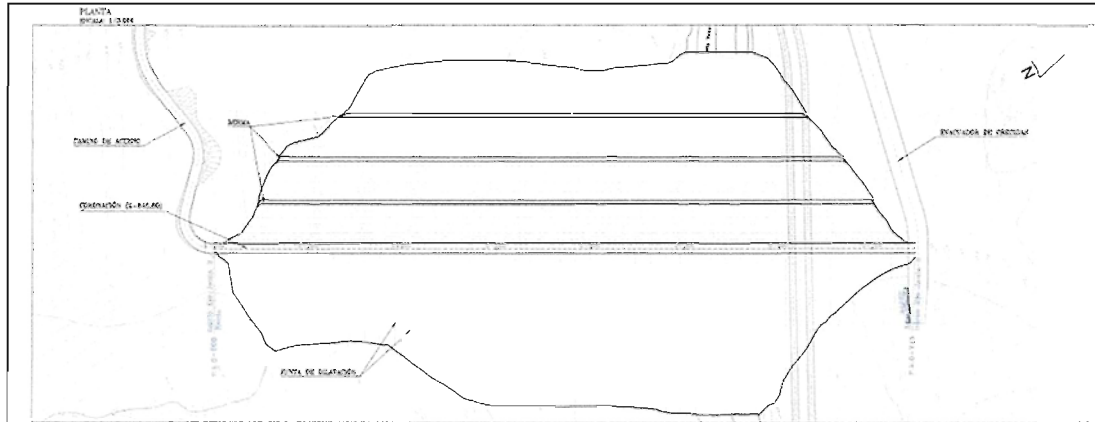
Plano de Planta. Alternativa La Jaula 2
